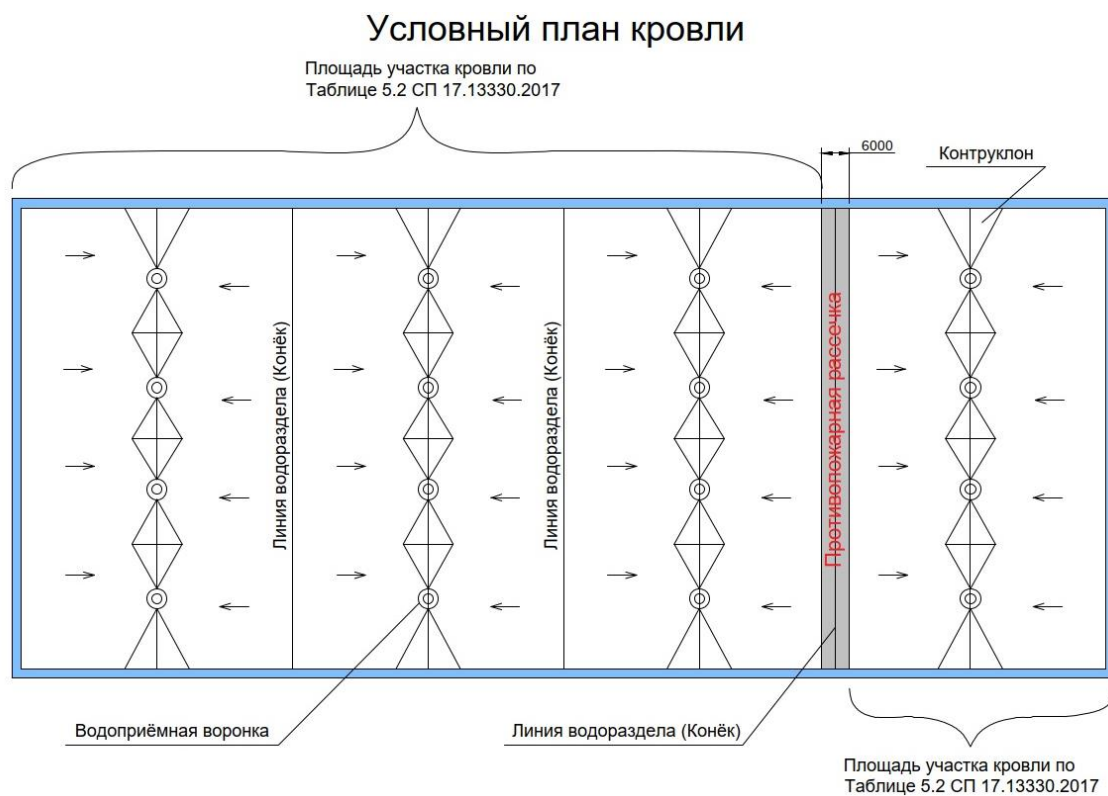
Схема возможного устройства противопожарного пояса на кровле
